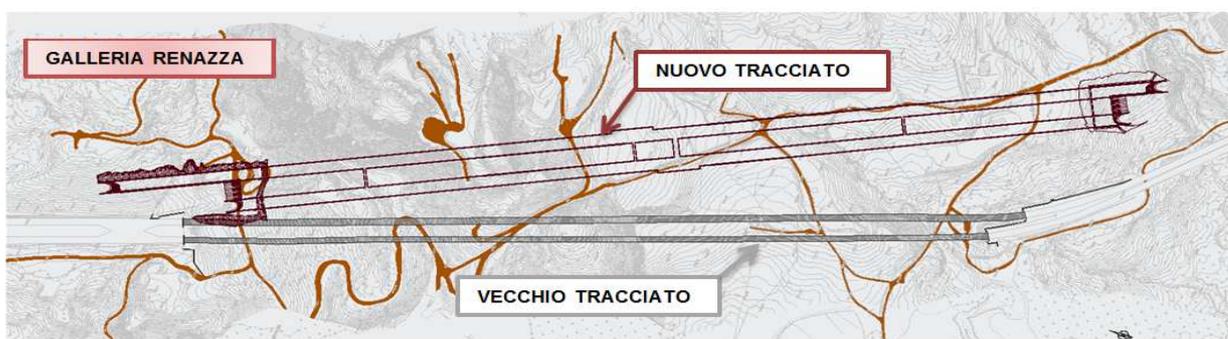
Ubicazione della Galleria Renazza rispetto al nuovo tracciato.
